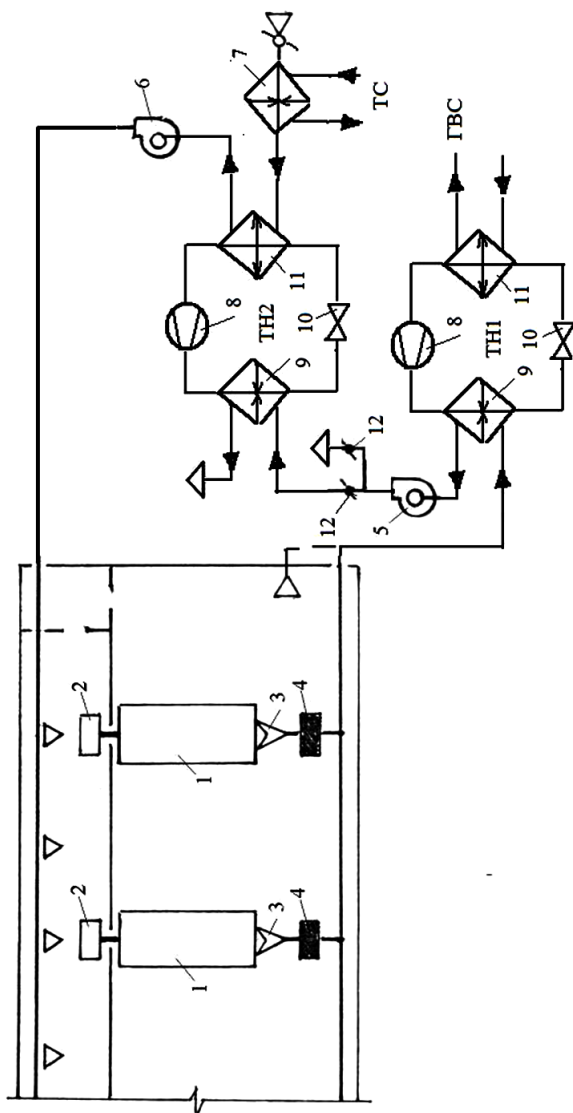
Схема для отопления галереи нагревателей и ГВС многомашинного КЦ: 1 – ГТУ; 2 – нагреватель газа; 3 – местный отсос; 4 – противопожарный клапан; 5 – вытяжной вентилятор; 6 – приточный вентилятор; 7 – воздухонагреватель; 8 – компрессор; 9 – испаритель; 10 – терморегулирующий вентиль; 11 – конденсатор; 12 – клапаны
